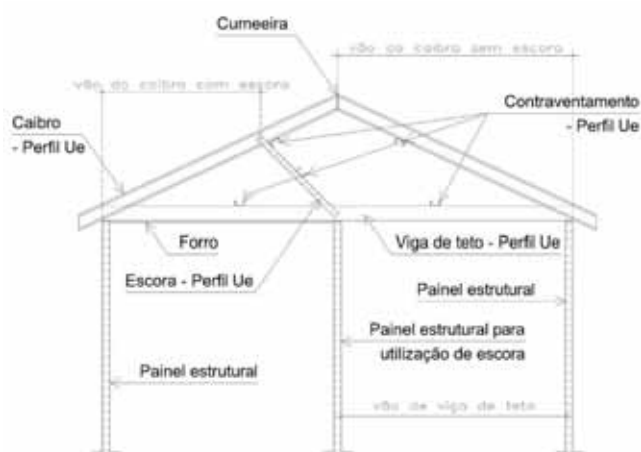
Cobertura estruturada com caibros e vigas.
